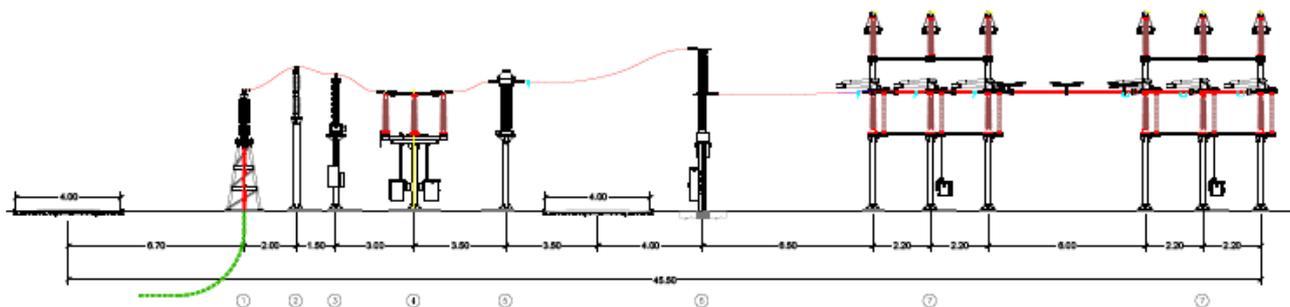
sezione futuro stallo di arrivo in Stazione Elettrica RTN
